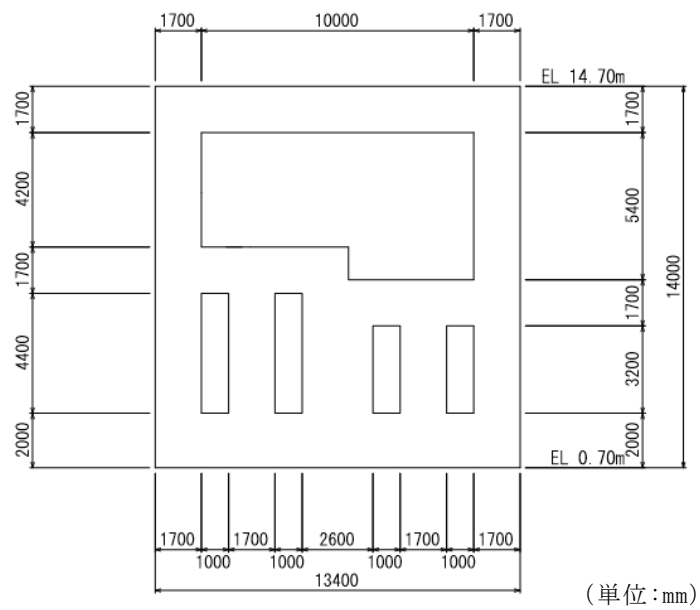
第 1 ベントフィルタ格納槽概略配筋図 (B-B 断面)
